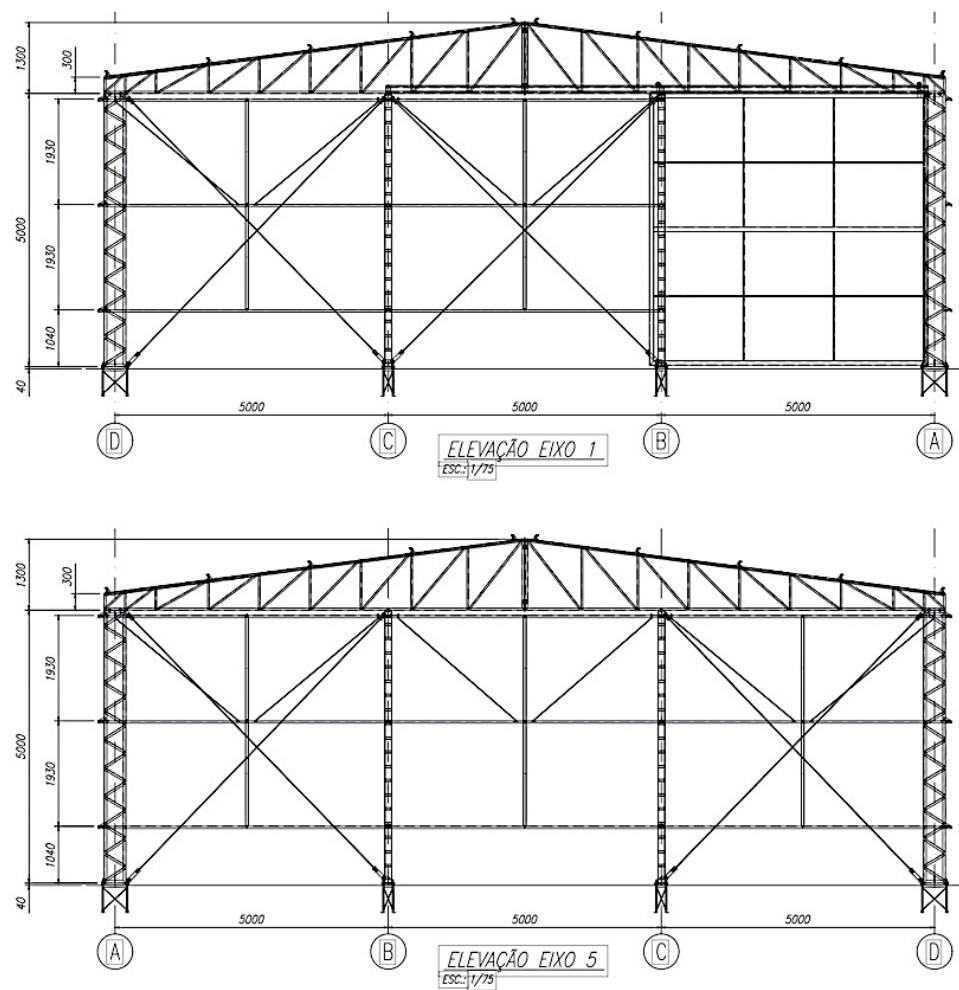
Alçado do eixo 1 e 5 AutoCAD
